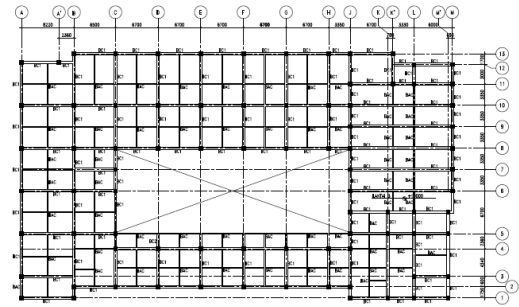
Denah kolom, balok dan pelat lantai Lower Ground
